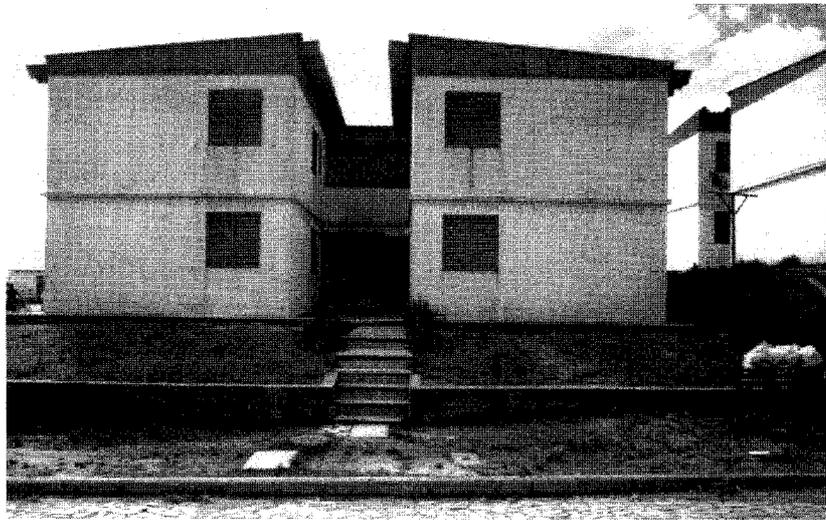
Os blocos de apartamentos com 2 pavimentos - Tancredo Neves
